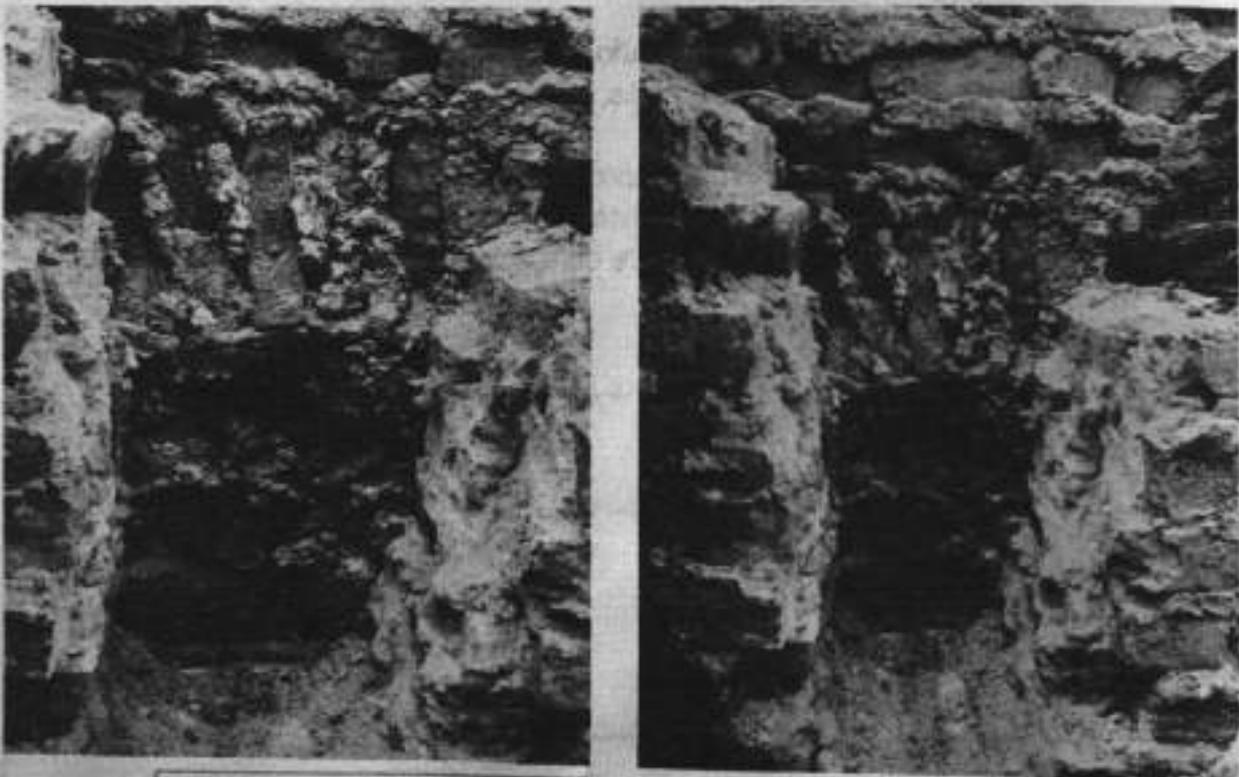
VISTA DE CIMENTACION EDIFICIO VECINO
